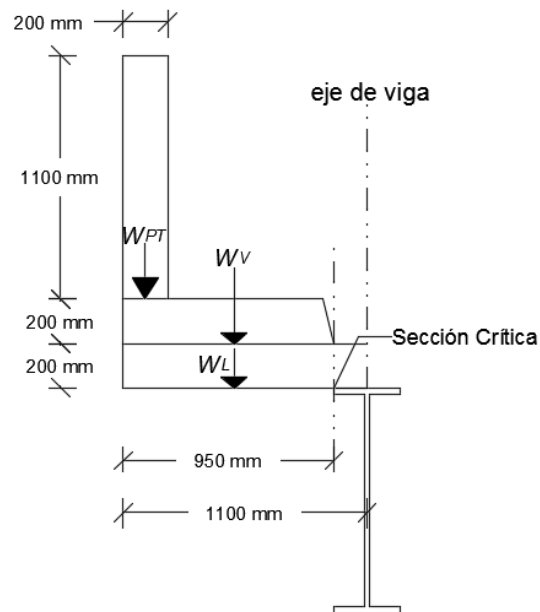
Sección transversal del volado y cargas de diseño. Realizado por: Autor
